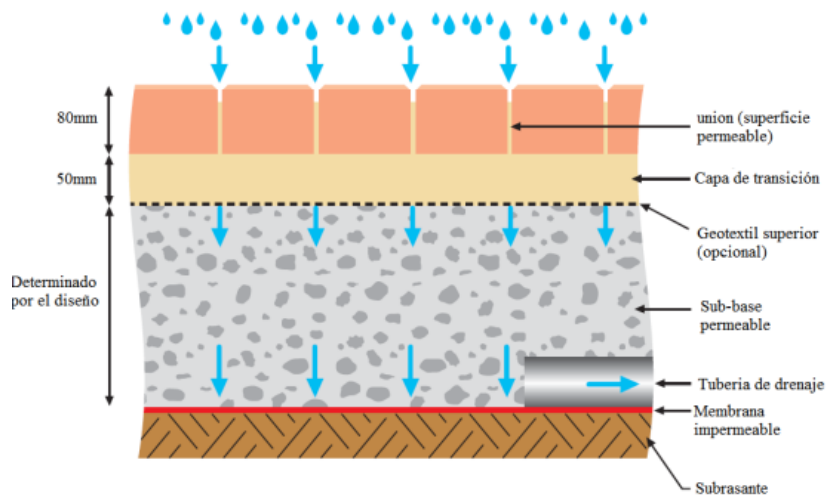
Estructura del pavimento permeable de infiltración 0. (Adaptado de: Interpave, 2008).
